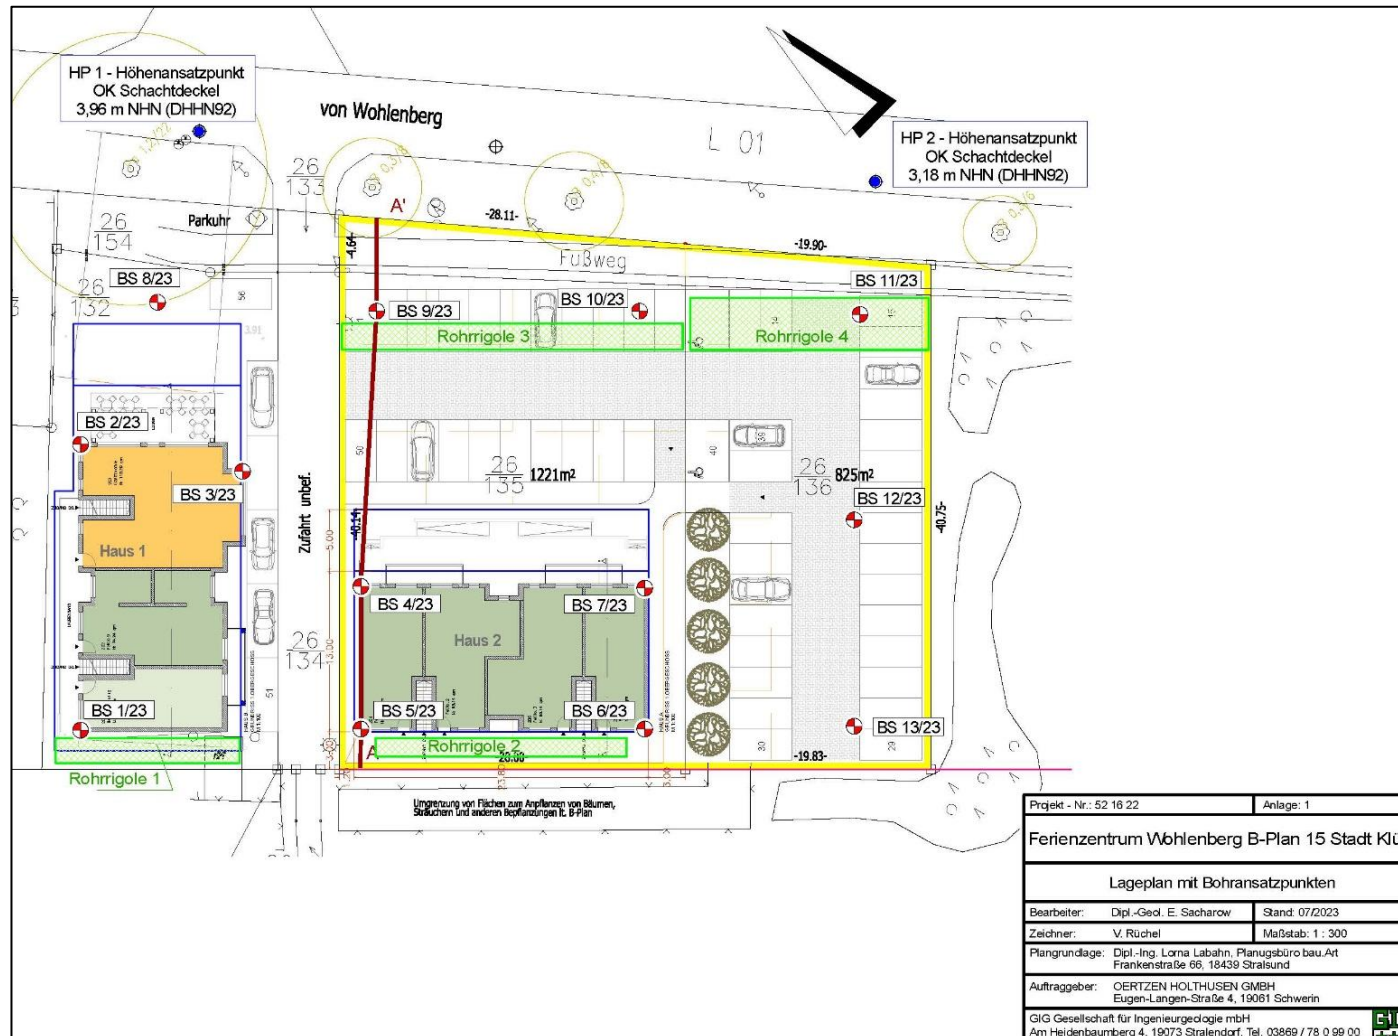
Auszug aus dem Lageplan Regenwasserversickerung
